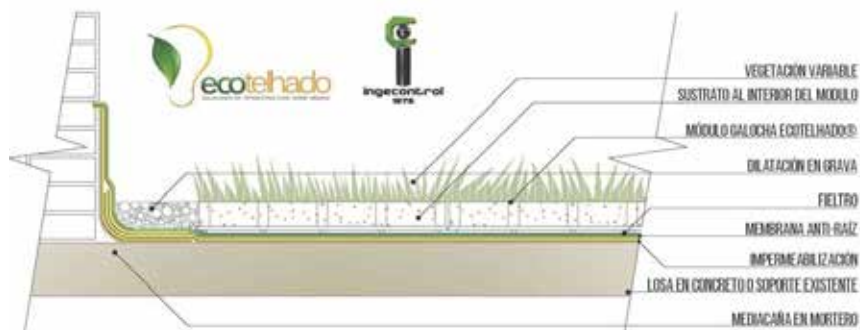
Sistema de Cubierta Verde Modular Galocha. Ecotelhado (2016).
